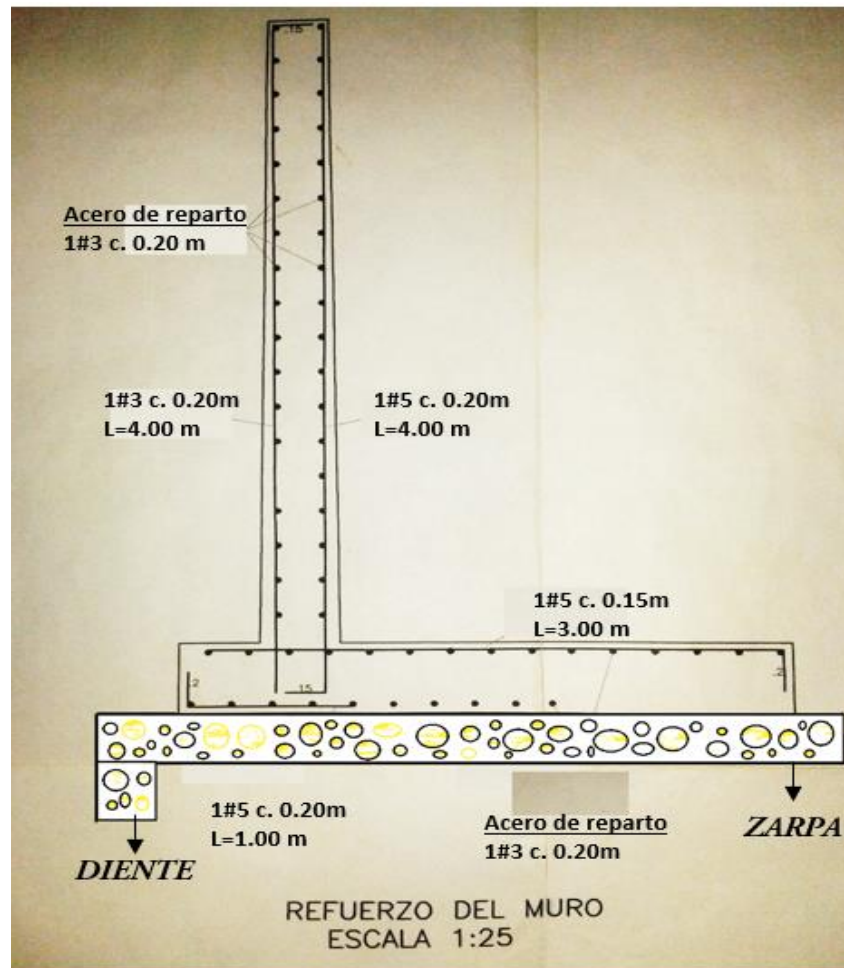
Diseño de muro apoyado en concreto ciclópeo.
